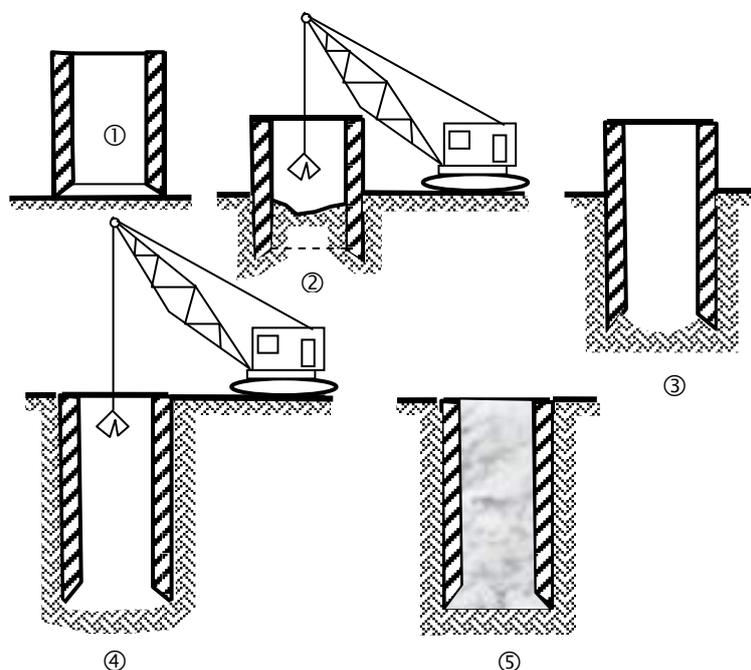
Этапы устройства фундаментов из опускных колодцев:
